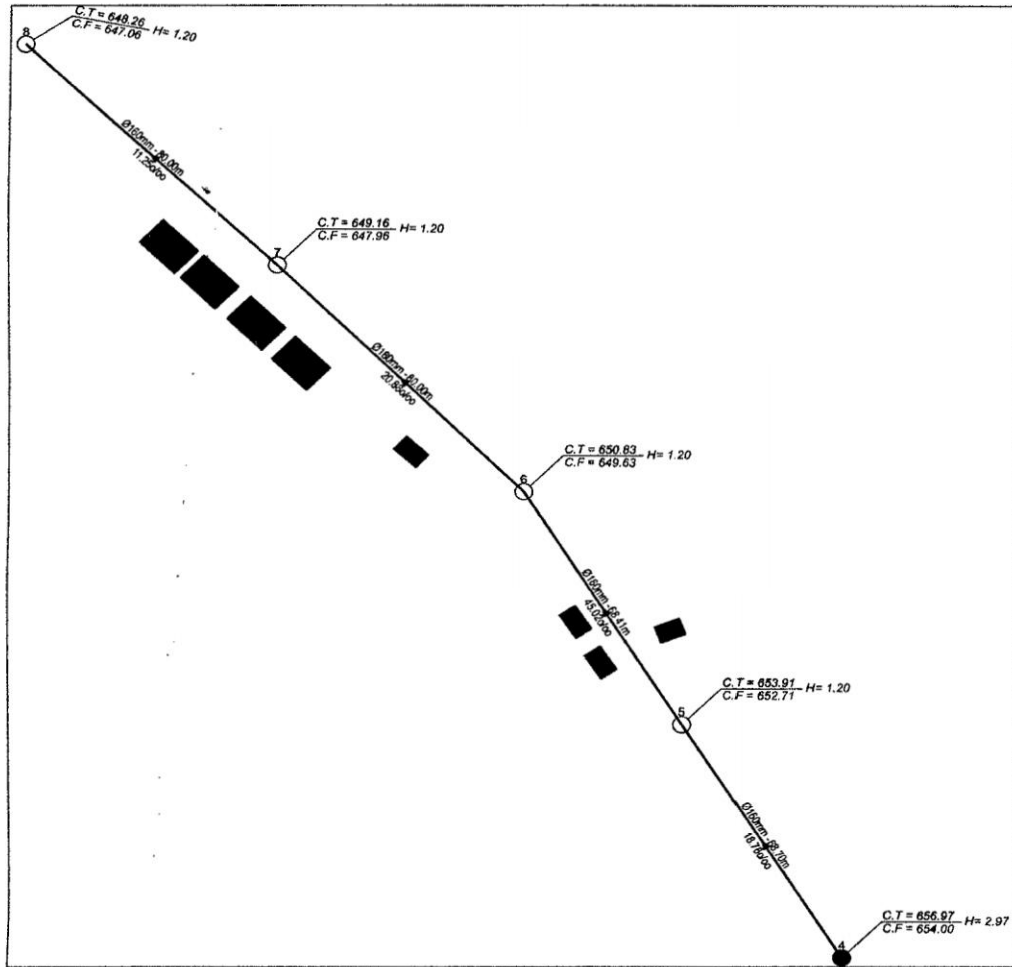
Plano en planta y diagrama de flujo del buzón N° 4 a 8. Fuente:
